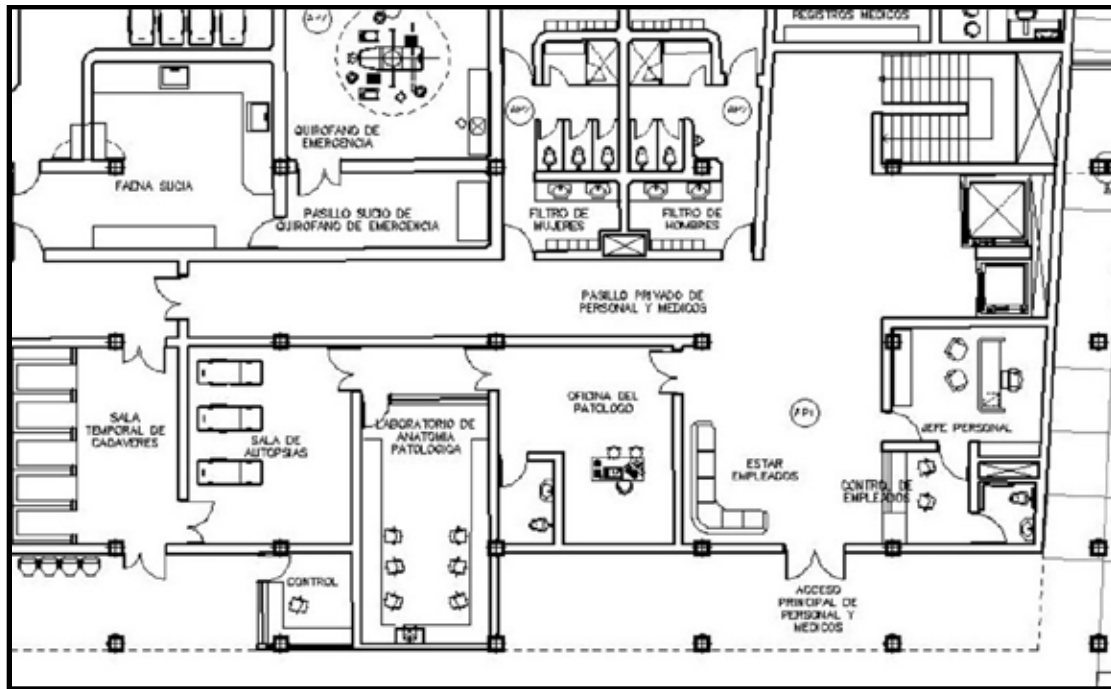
Planta Baja Ala-2 Anatomía Patológica y acceso de Empleados.
